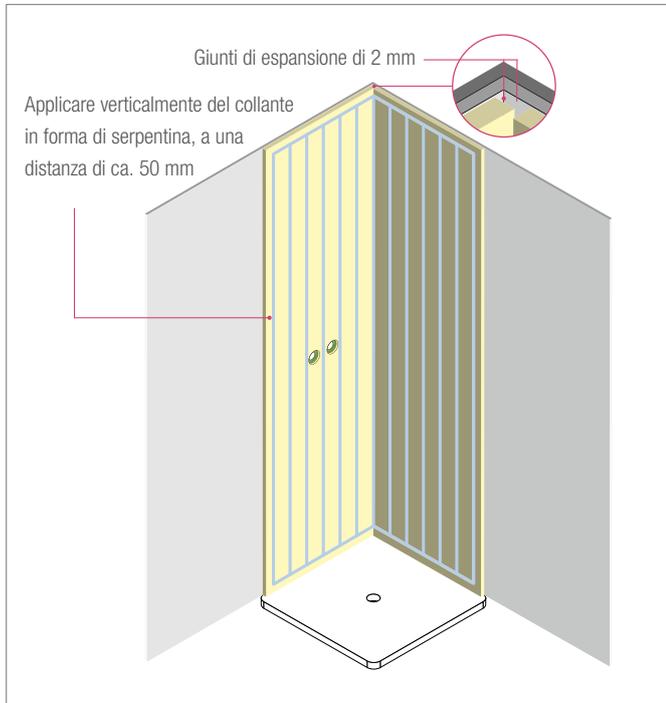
Giunti di espansione e fissaggio di RAUVISIO crystal slim alla parete
